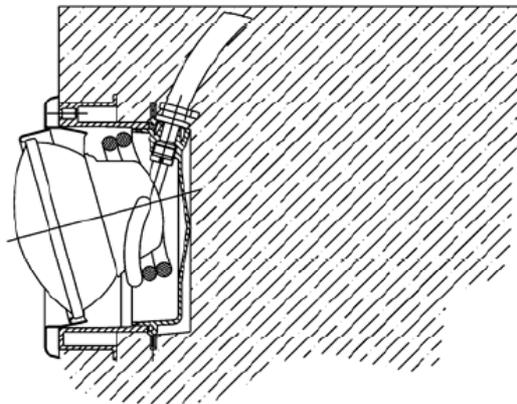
Unterwasserscheinwerfer mit aufgewickelten Anschlusskabel im Einbaugehäuse
